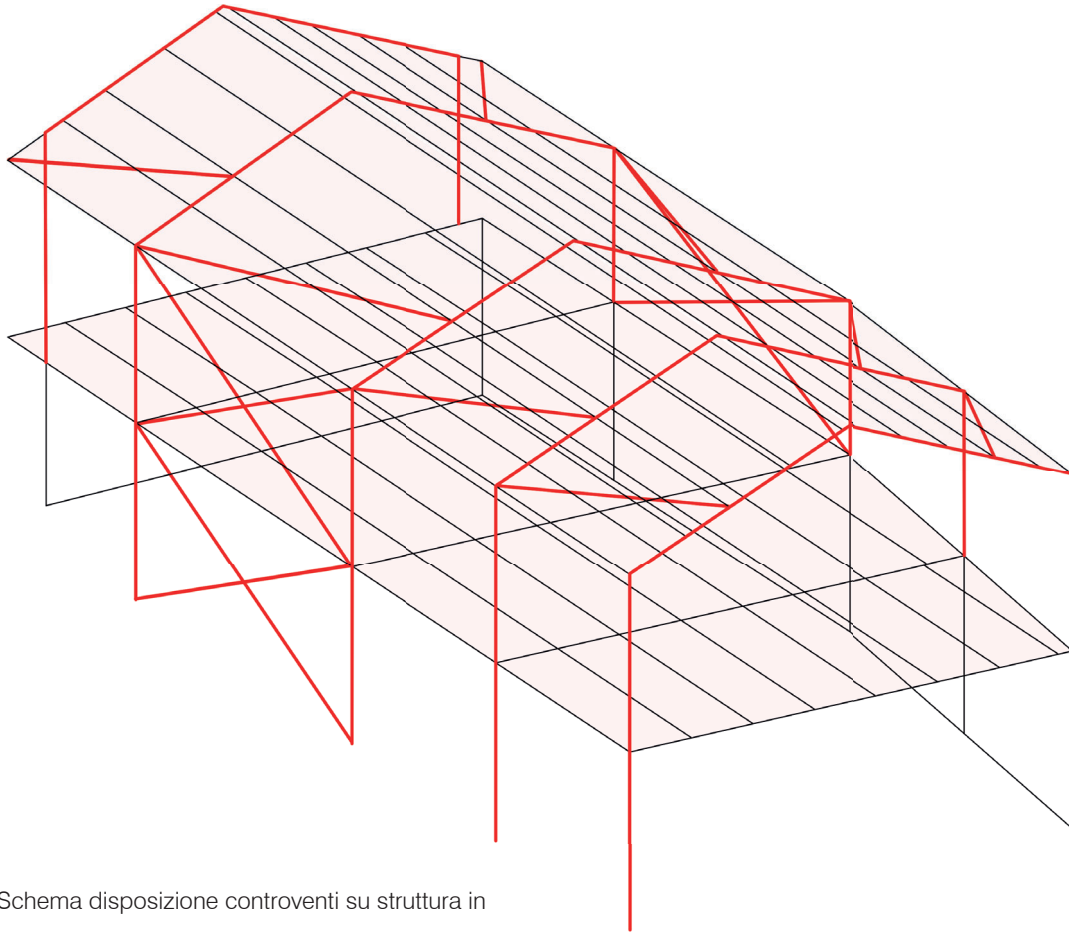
Schema disposizione controventi su struttura in acciaio
